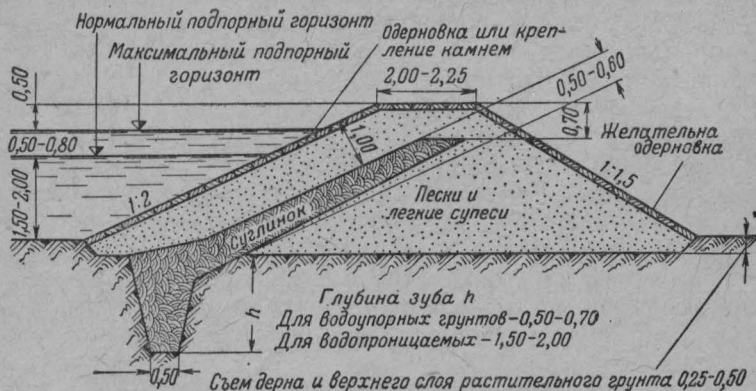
Поперечное сечение земляной плотины из водопроницаемых грунтов с наклонным глинистым экраном
